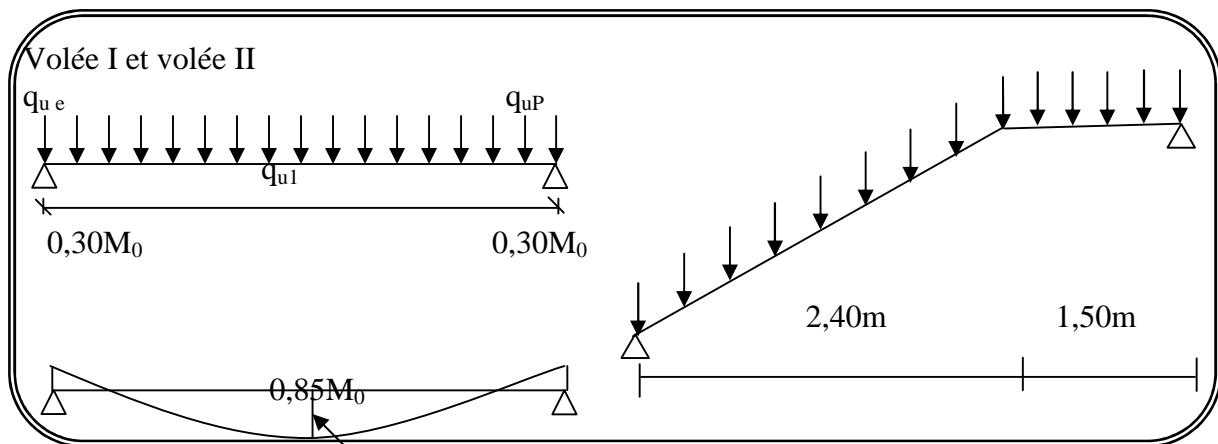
Schéma d'escalier rez-de-chaussée volée I.
